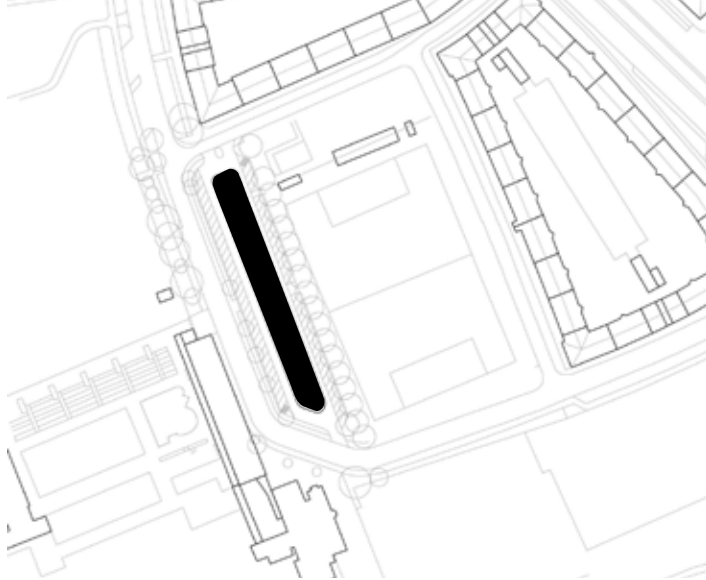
Lageplan, Quelle: Florian Nagler Architekten
